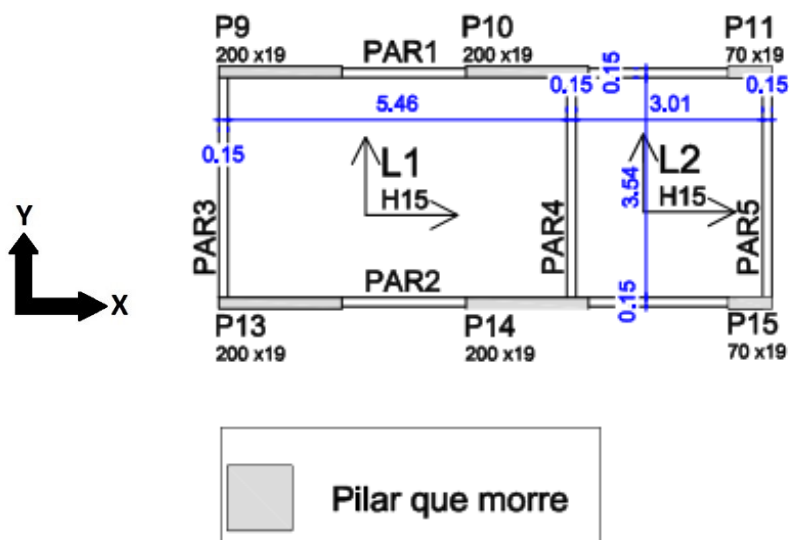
Planta de formas da CASA DE MÁQUINAS
